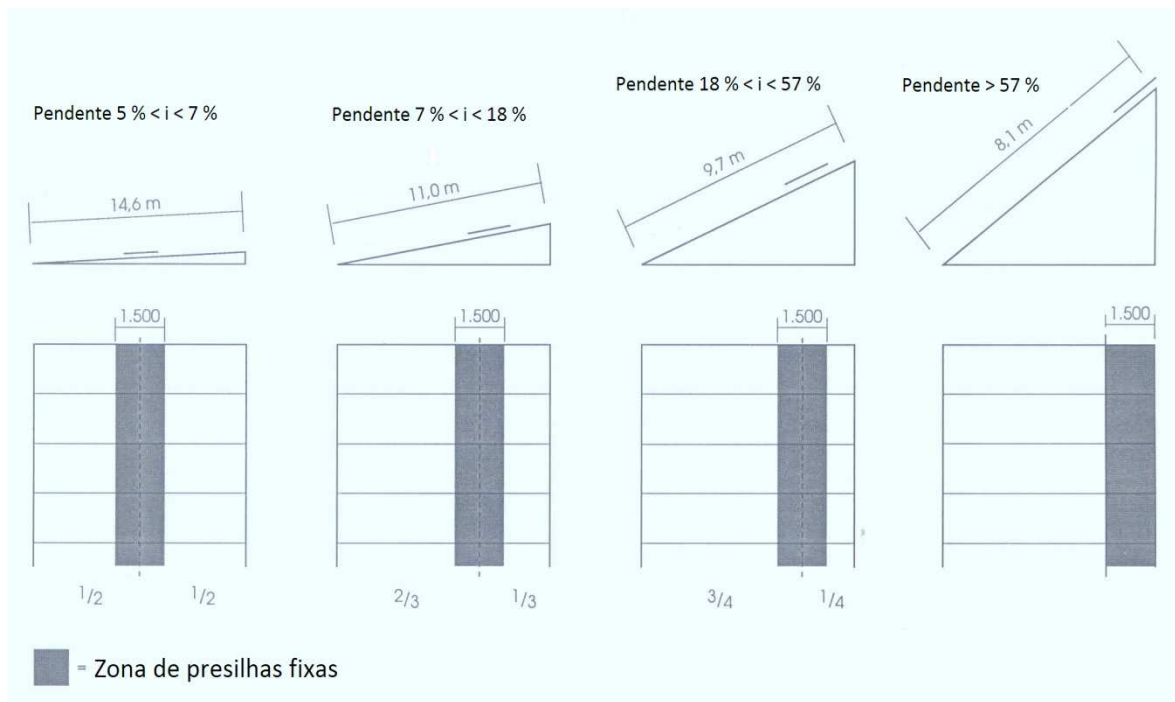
Pendentes e comprimentos de chapas para coberturas em cobre
